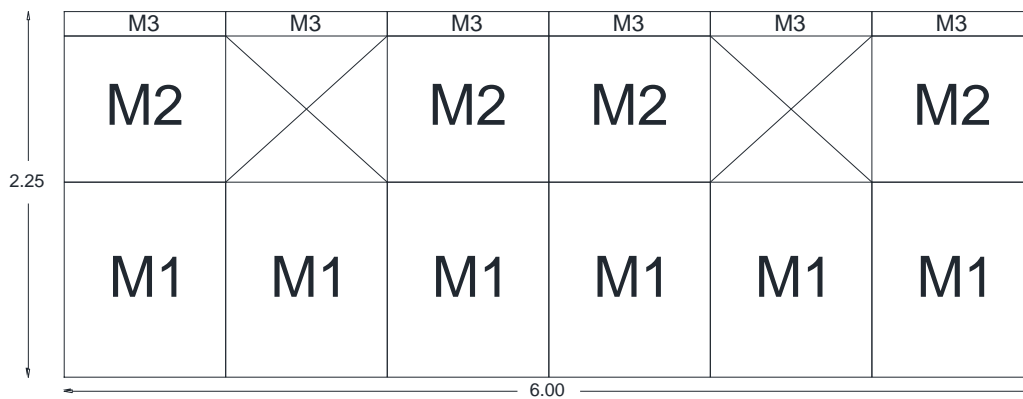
Armado de módulos para el muro 3 de la vivienda tipo social.
